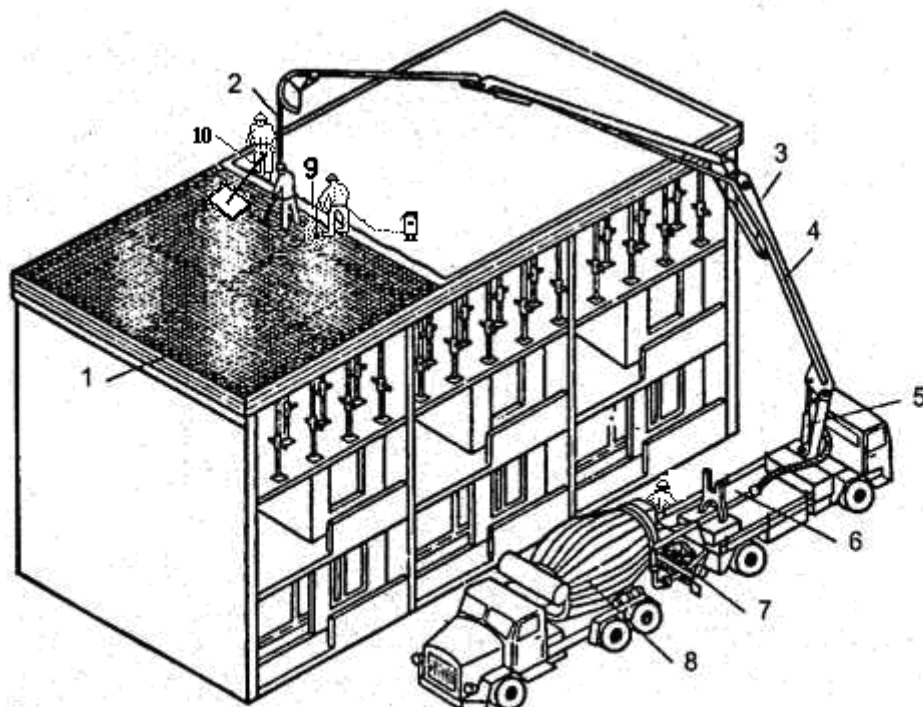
Укладка бетонной смеси автобетононасосами: 1 - укладка бетона; 2 - рукав; 3 - шарнирная стрела; 4 - бетоновод; 5 - гидроцилиндр; 6 - авто бетононасос; 7 - приемный бункер; 8 - автобетоносмеситель; 9 – глубинный вибратор; 10 - гладилка
